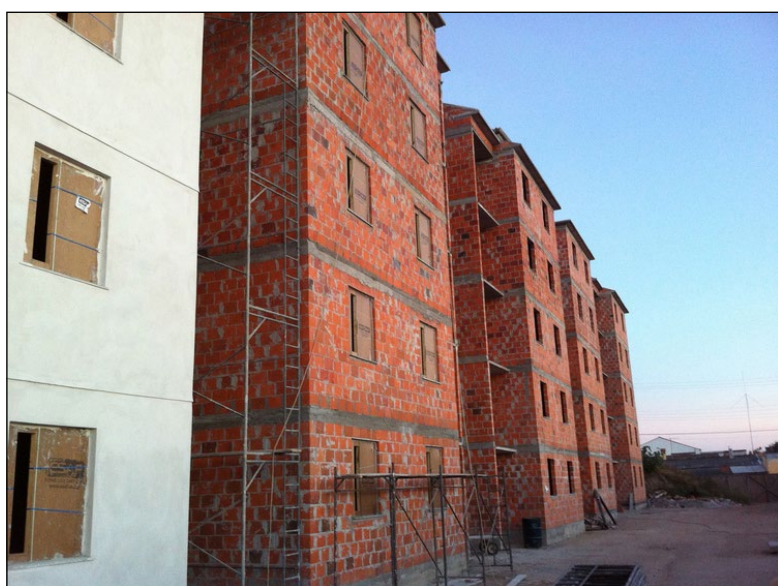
Bloco estrutural cerâmico utilizado nas paredes da HIS
